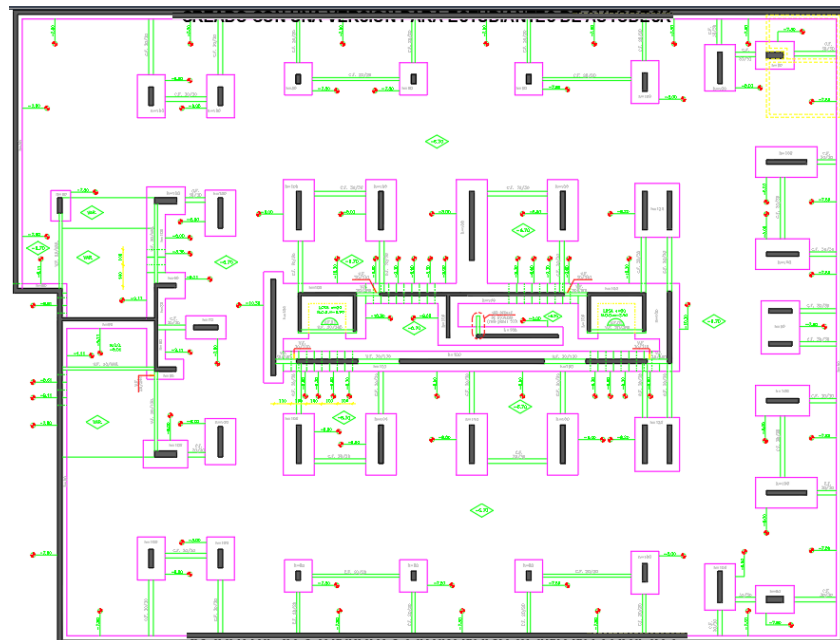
Plano Planta de fundaciones, edificio de 6 pisos.
